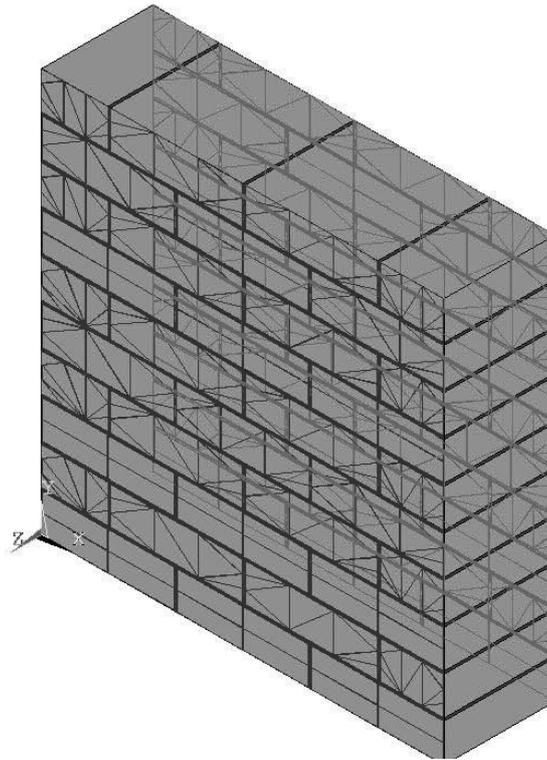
Разбиение фрагмента кладки наружной стены на конечные элементы
